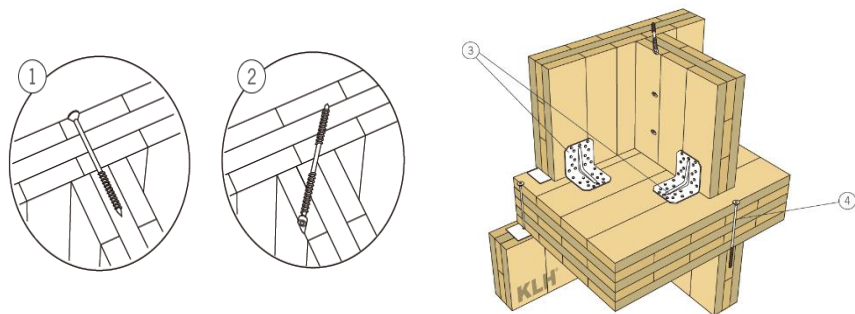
Узел примыкания стеновых панелей к плите перекрытия: 1 - крепежный анкер (прямой способ крепления снаружи здания); 2 - крепежный анкер (косой способ крепления внутри здания); 3 - Г-образные крепежные пластины; 4 - крепежный анкер.
